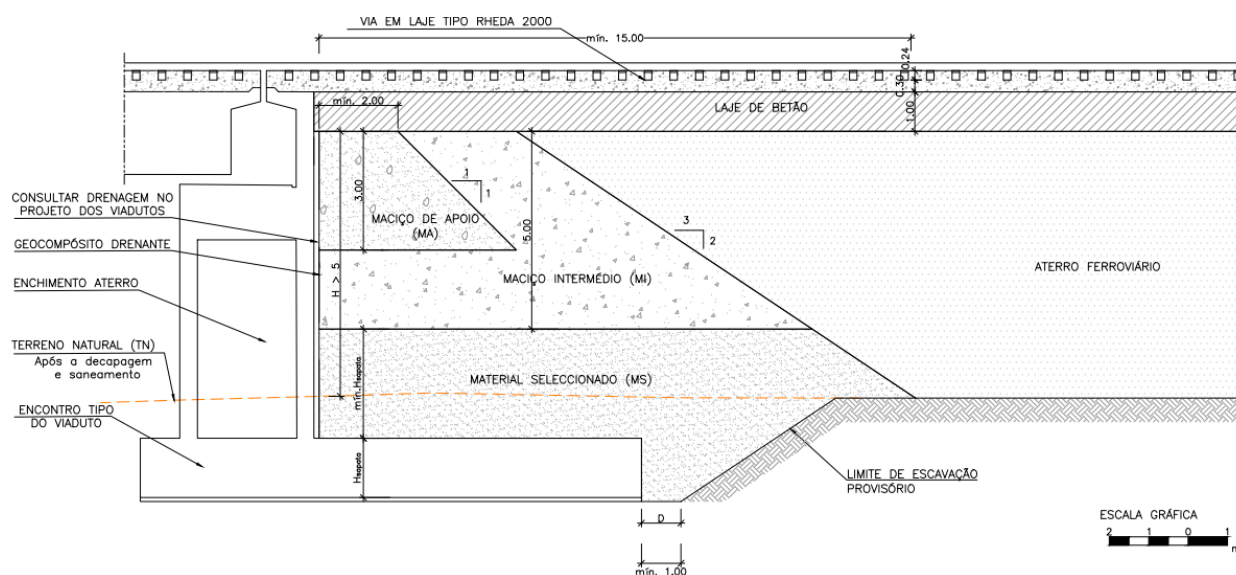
Bloco Técnico - Encontro de OA - Transição para via em laje em aterro
